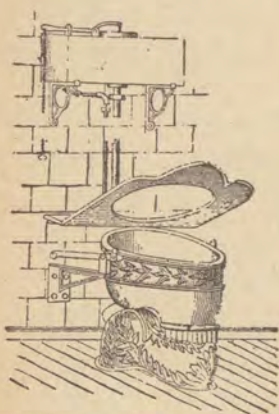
Retrete con tablero aislado de la cubeta y giratorio ó de charnela.
